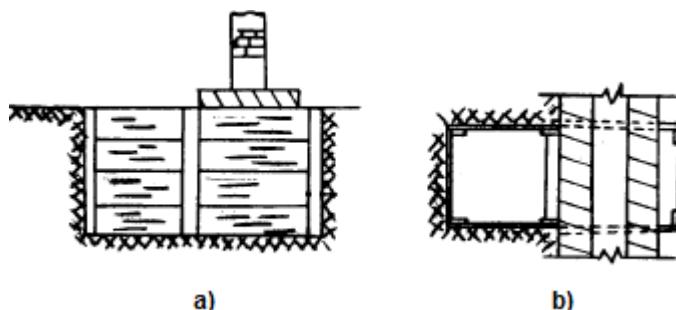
Prolongamento e escoramento do antepoço sob a fundação a recalçar: a) alçado; b) planta [32]
